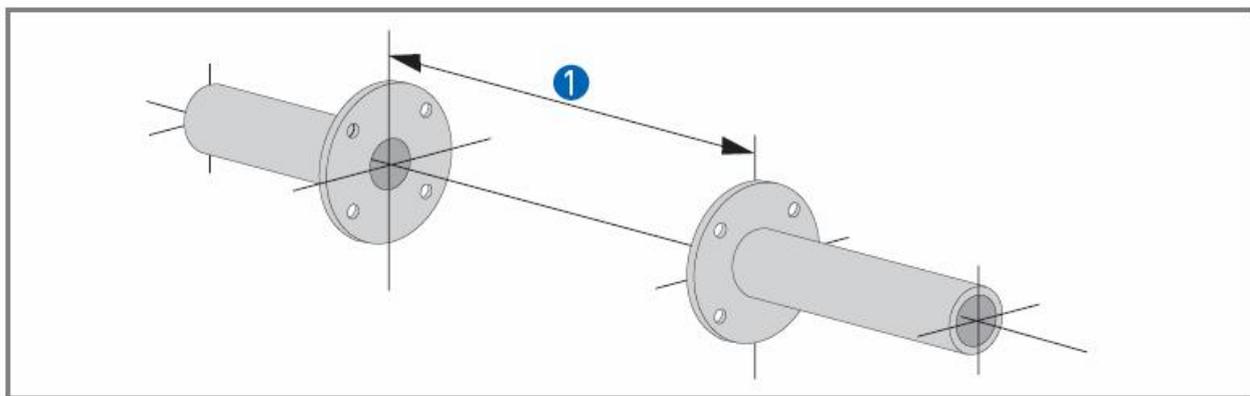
Подготовка участка трубопровода к монтажу расходомера
